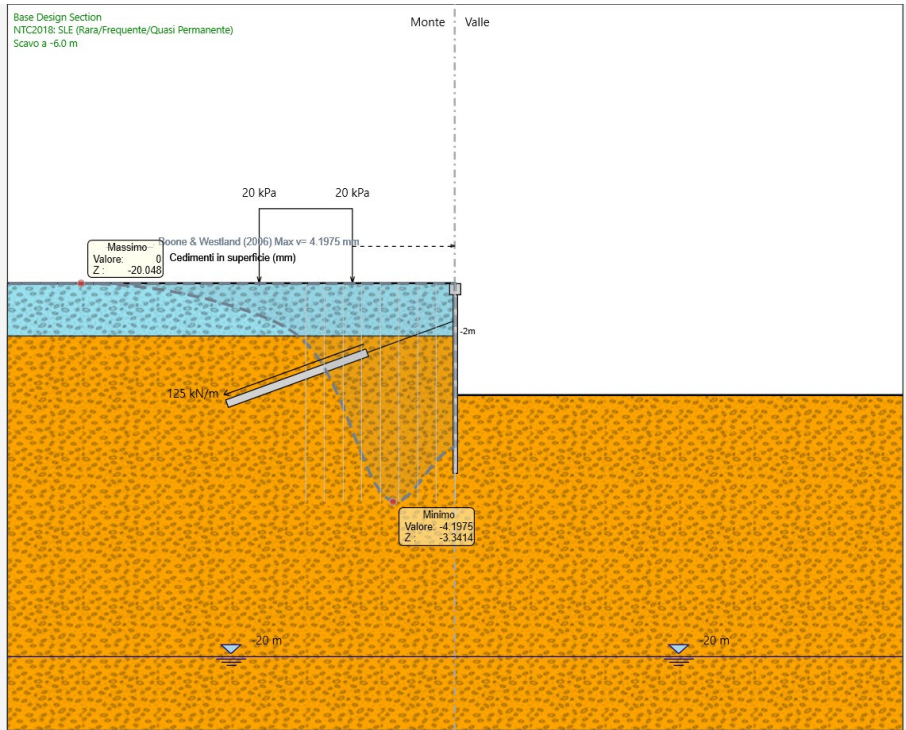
Sezione Tipo B – Spostamenti stima cedimenti
